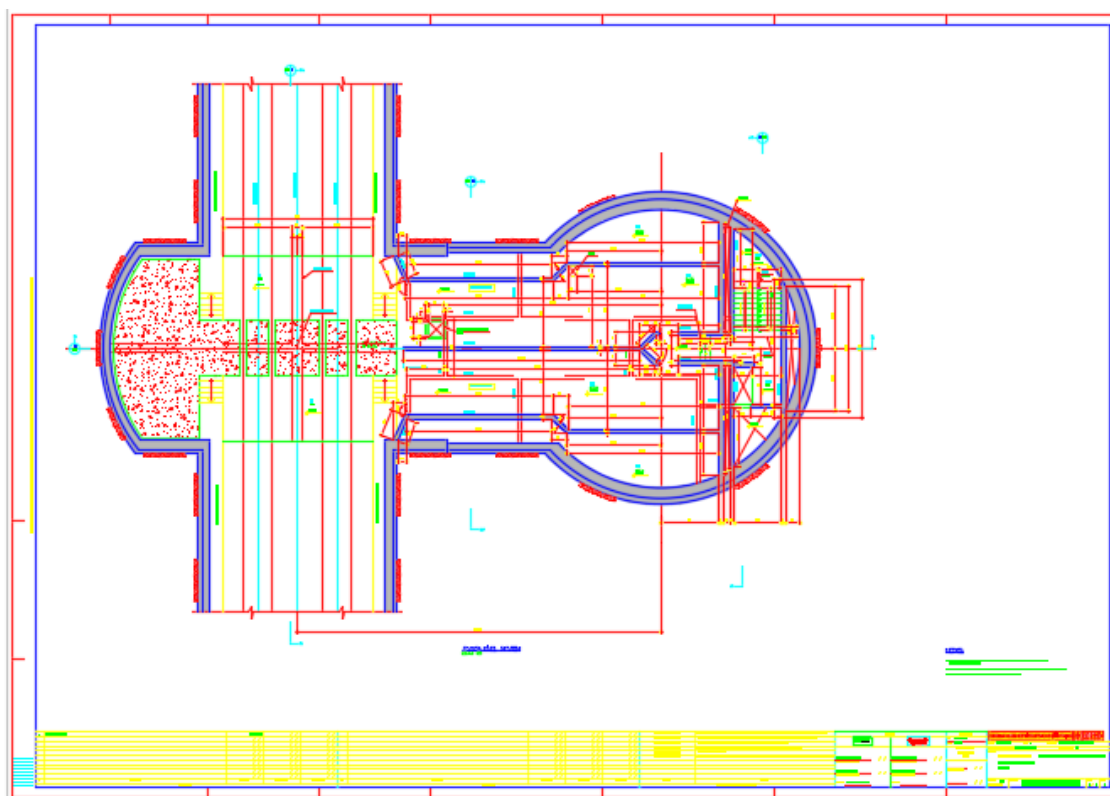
Planta de pavimento do poço (Maffei Engenharia)
